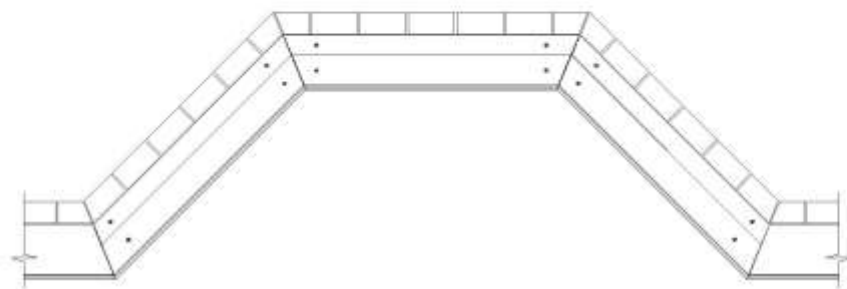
Техническое решение крепления сборных перемычек к железобетонным перекрытиям в местах устройства эркеров
